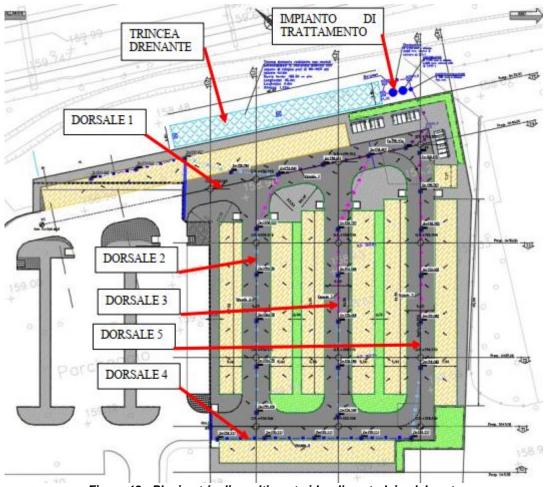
Planimetria di smaltimento idraulico stralcio elaborato
